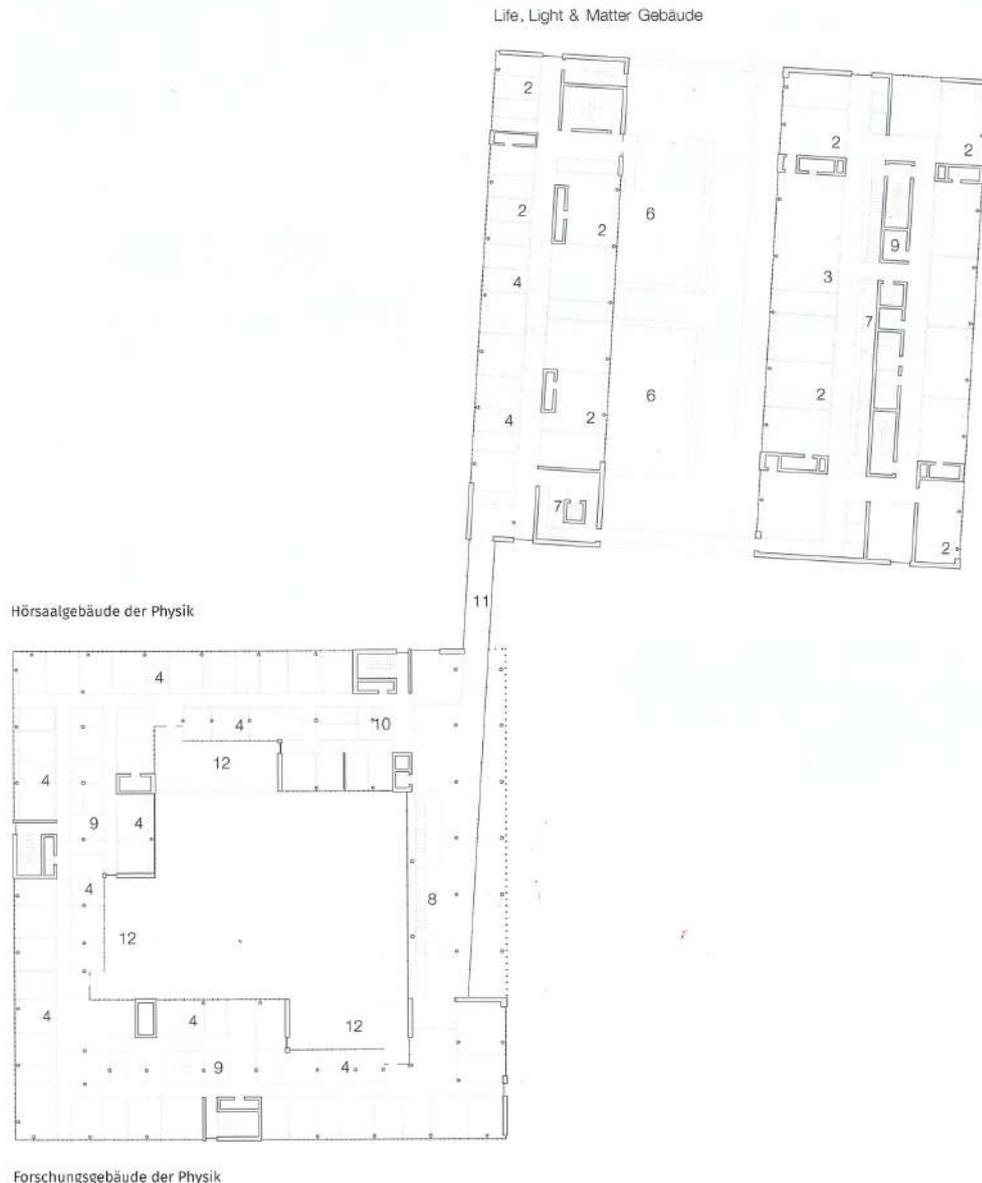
Grundriss 1. Obergeschoss (Grafiken 2, 7 und 8: Gerber Architekten)
